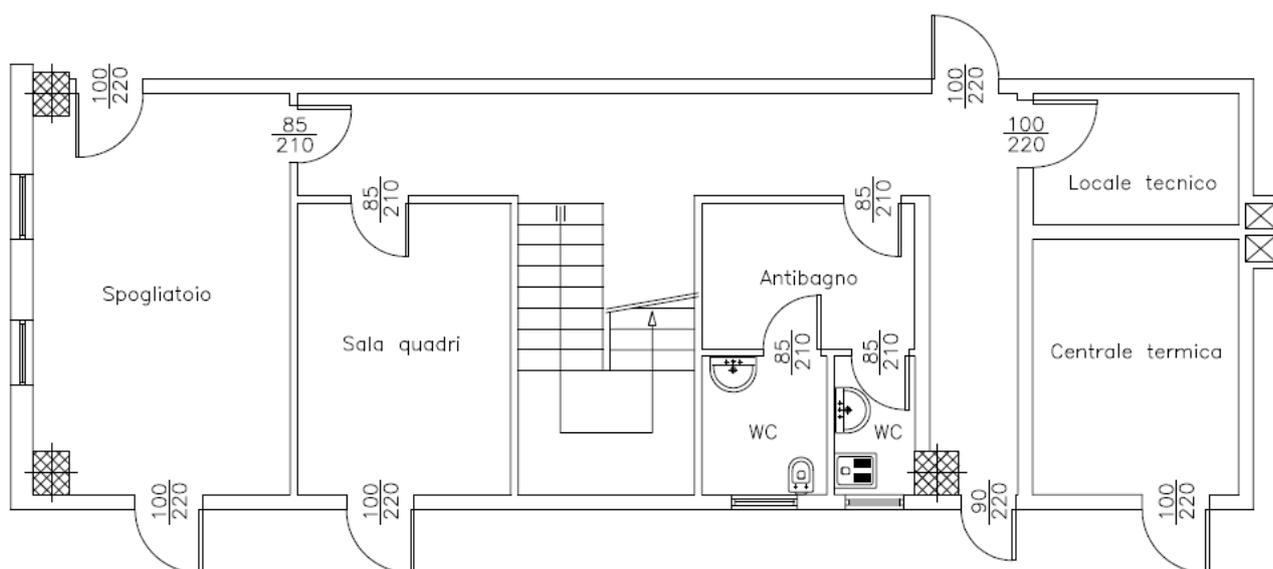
Pianta piano terreno dell'edificio adibito ad uffici a Roccavione.
